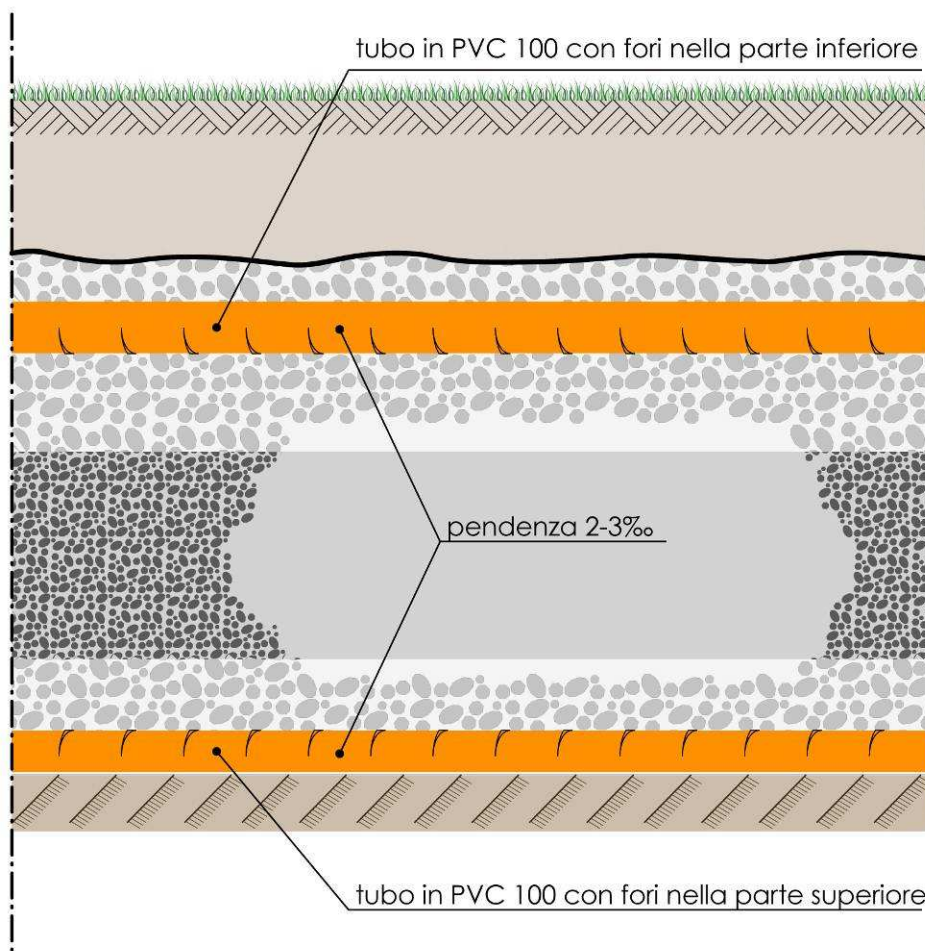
Sezione verticale longitudinale di una trincea di un sistema di subdispersione con drenaggio.
